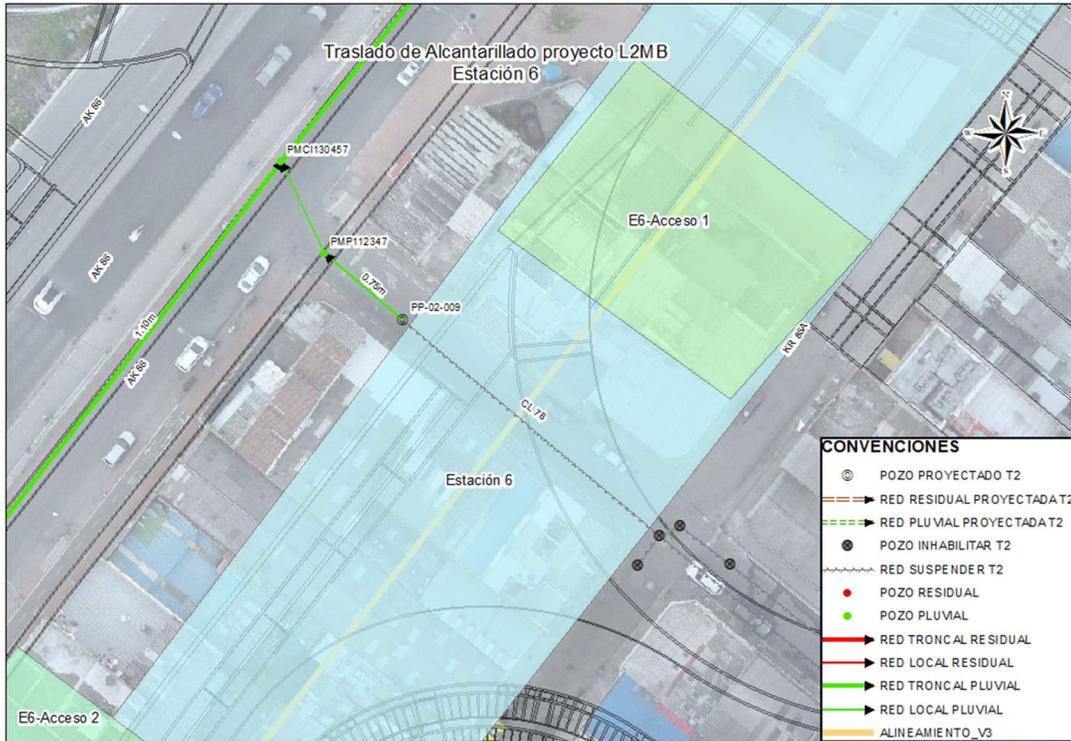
Traslado redes de alcantarillado Estación 6 Av Cali con calle 77A Red pluvial
